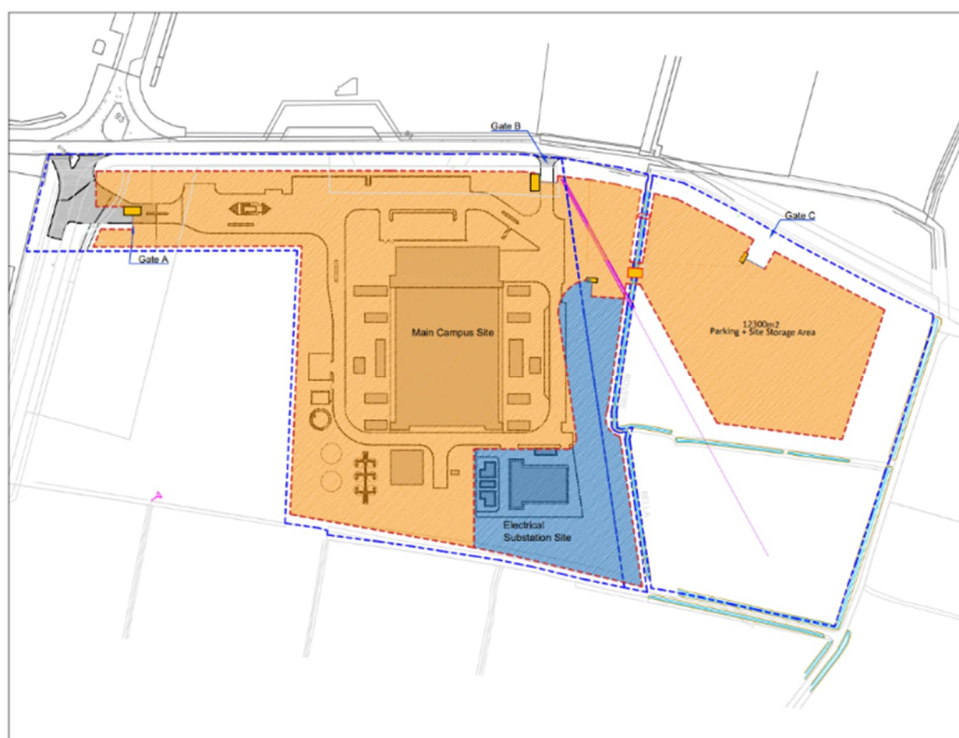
Occupazione temporanea delle aree di cantiere previste.
